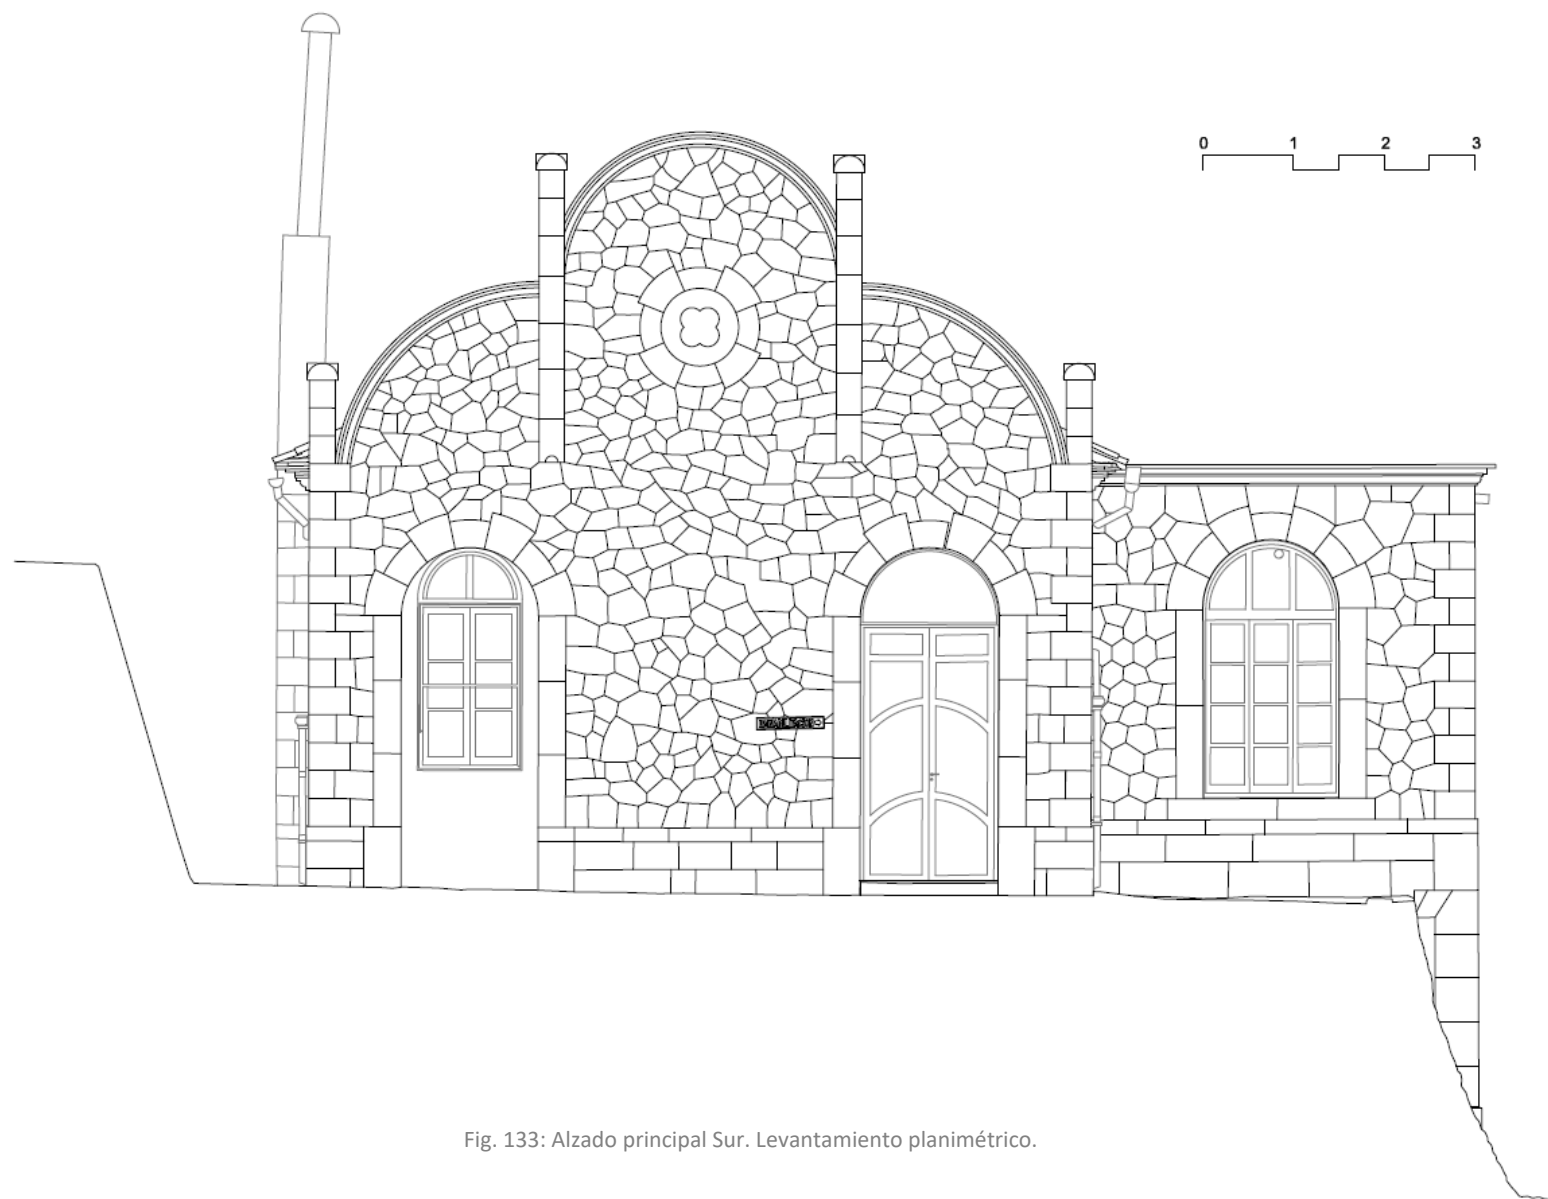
Alzado principal Sur. Levantamiento planimétrico.
